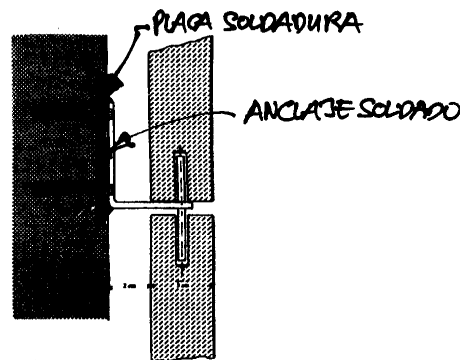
Sistemas de fijación de anclaje con placa de soldadura
